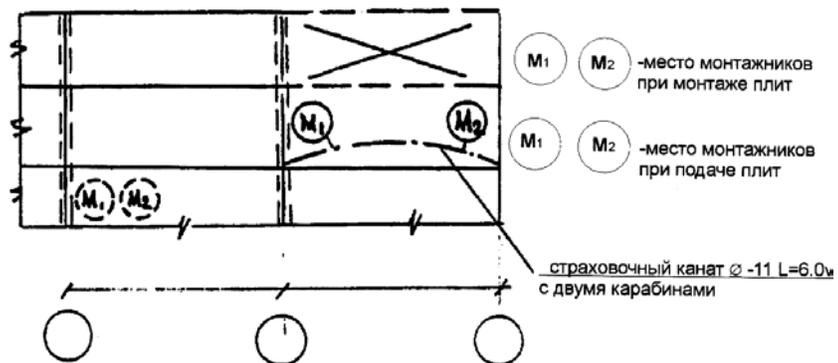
Организация рабочего места монтажника при монтаже плит перекрытия (покрытия)
